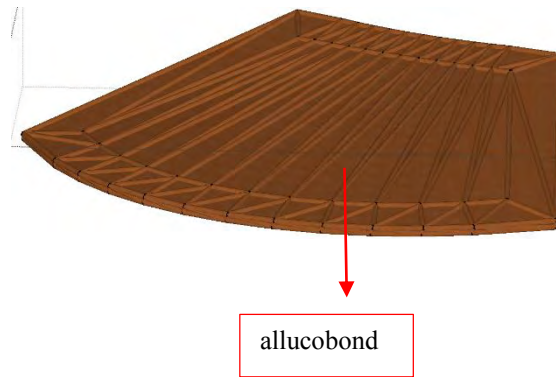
Pengaplikasian balok dan kolom rangka baja
